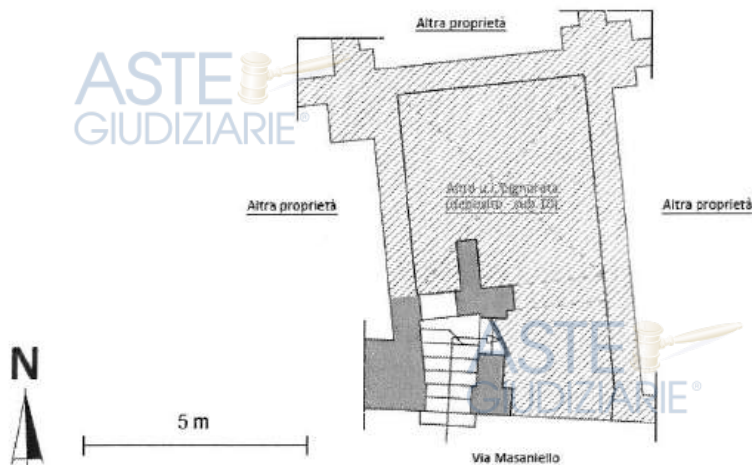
Planimetria dello stato reale dei luoghi - Abitazione (Piano Terra)
